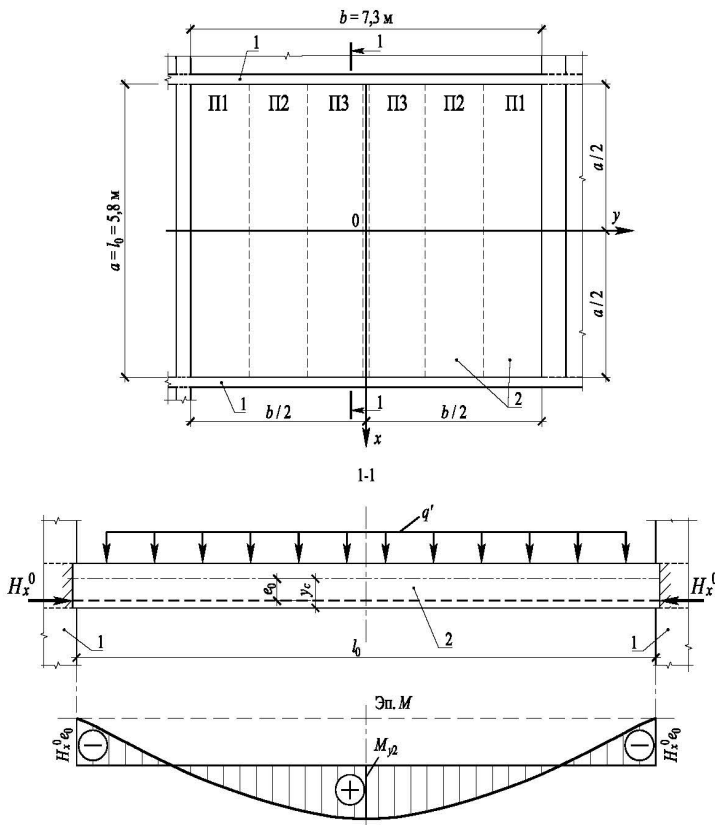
Размещение многопустотных плит в диске перекрытия, опертом на несущие стены, и схема усилий, действующих в них под нагрузкой: 1 – несущая стена; 2 – многопустотная плита
